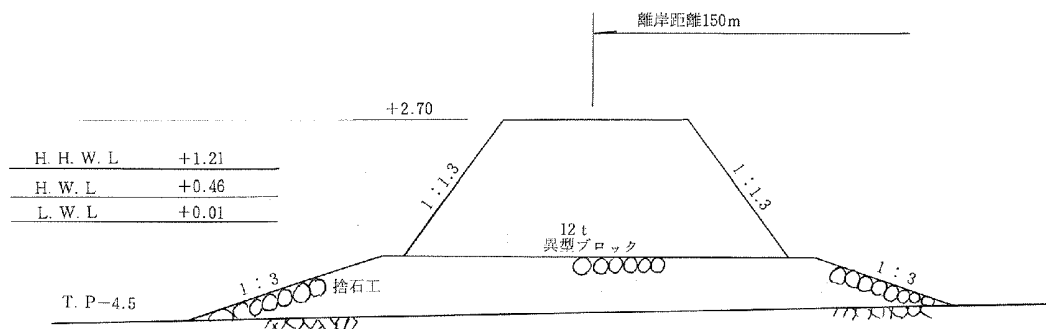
施工事例 異形ブロックを用いた離岸堤標準断面図（石川海岸）
